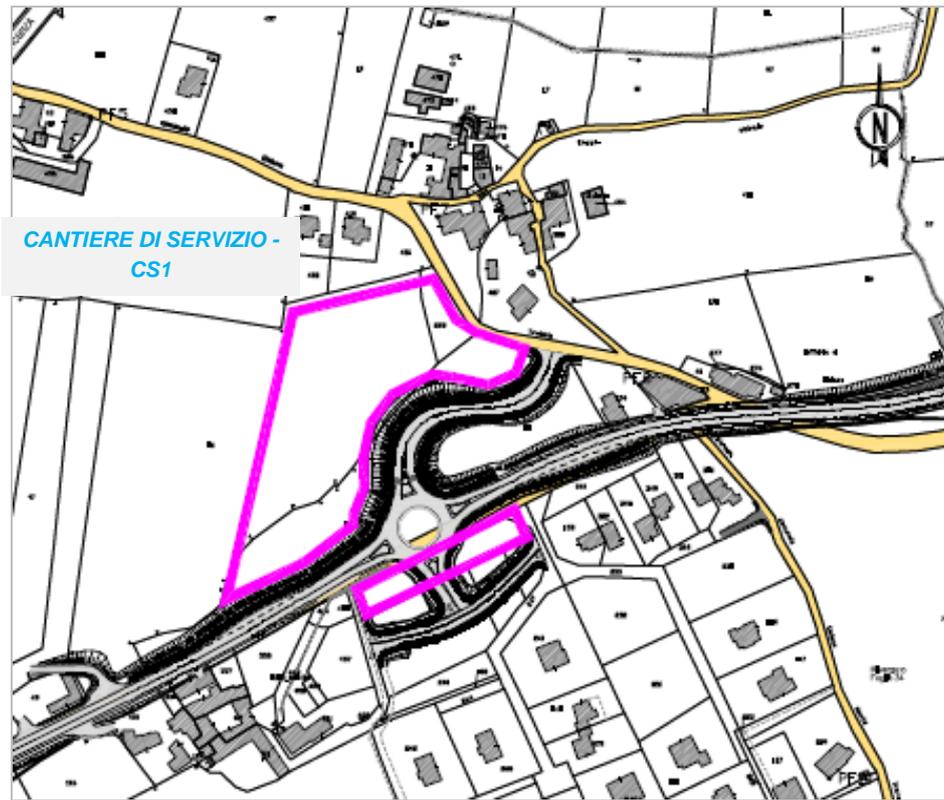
PLANIMETRIA CATASTALE CANTIERE DI SERVIZIO CS1
